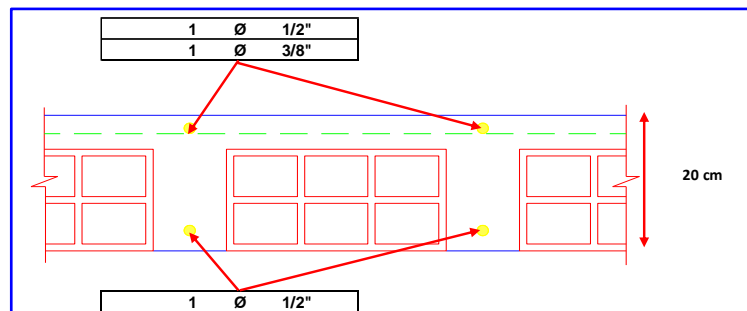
Detalle del Acero en Vigueta del Módulo A2
